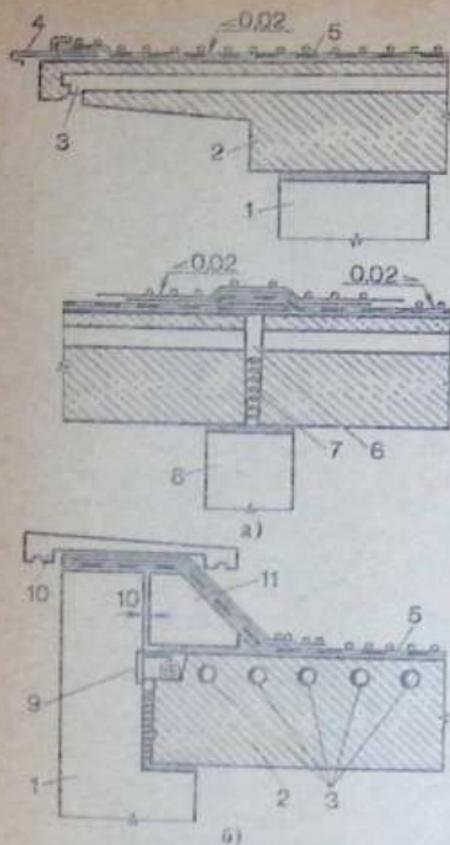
Бесчердачное вентилируемое покрытие из однослойных керамзитобетонных панелей:
